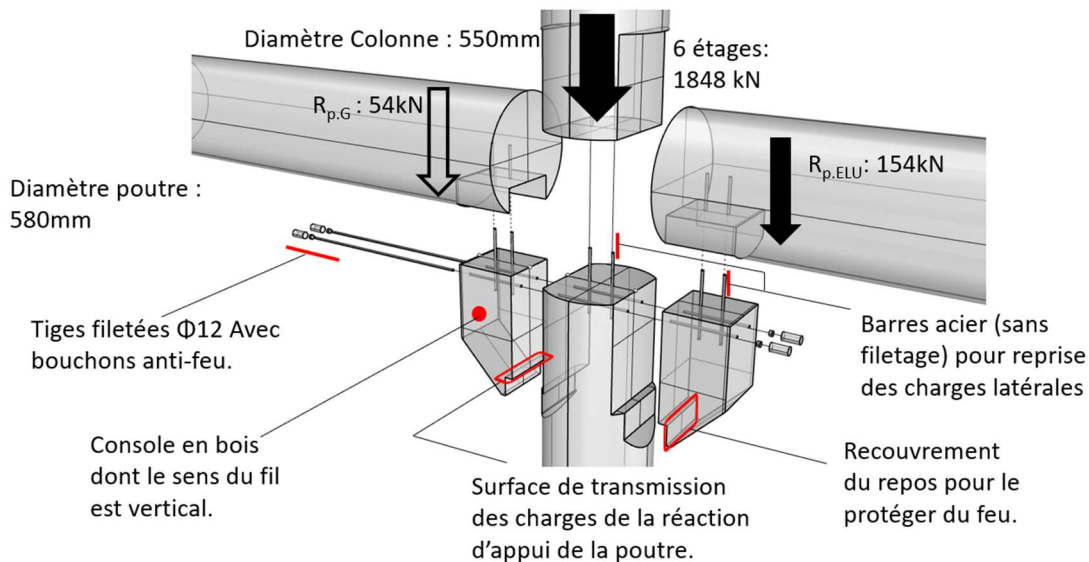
Exemple d'assemblage en console avec pièces rapportées en bois
